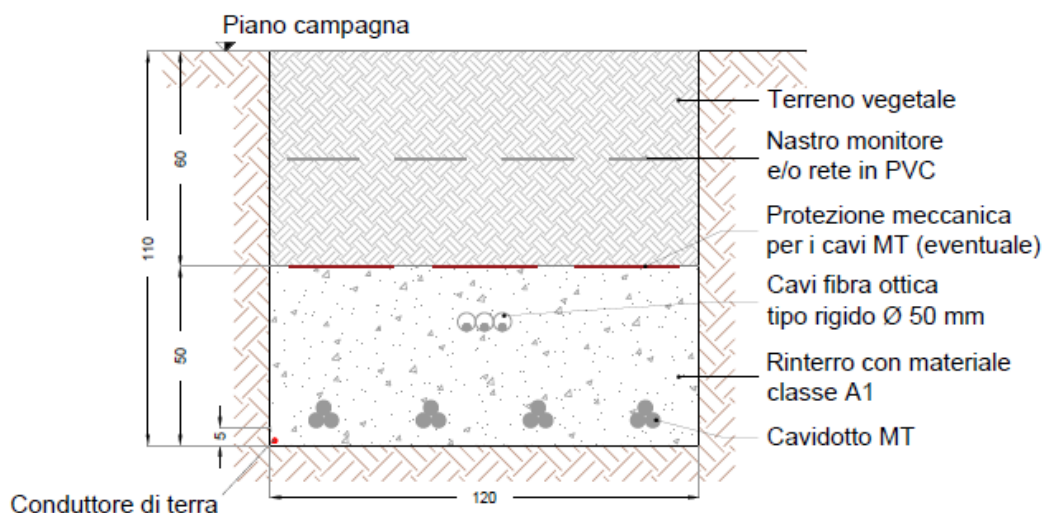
Sezione tipo cavidotto MT quattro terre su strada terreno
